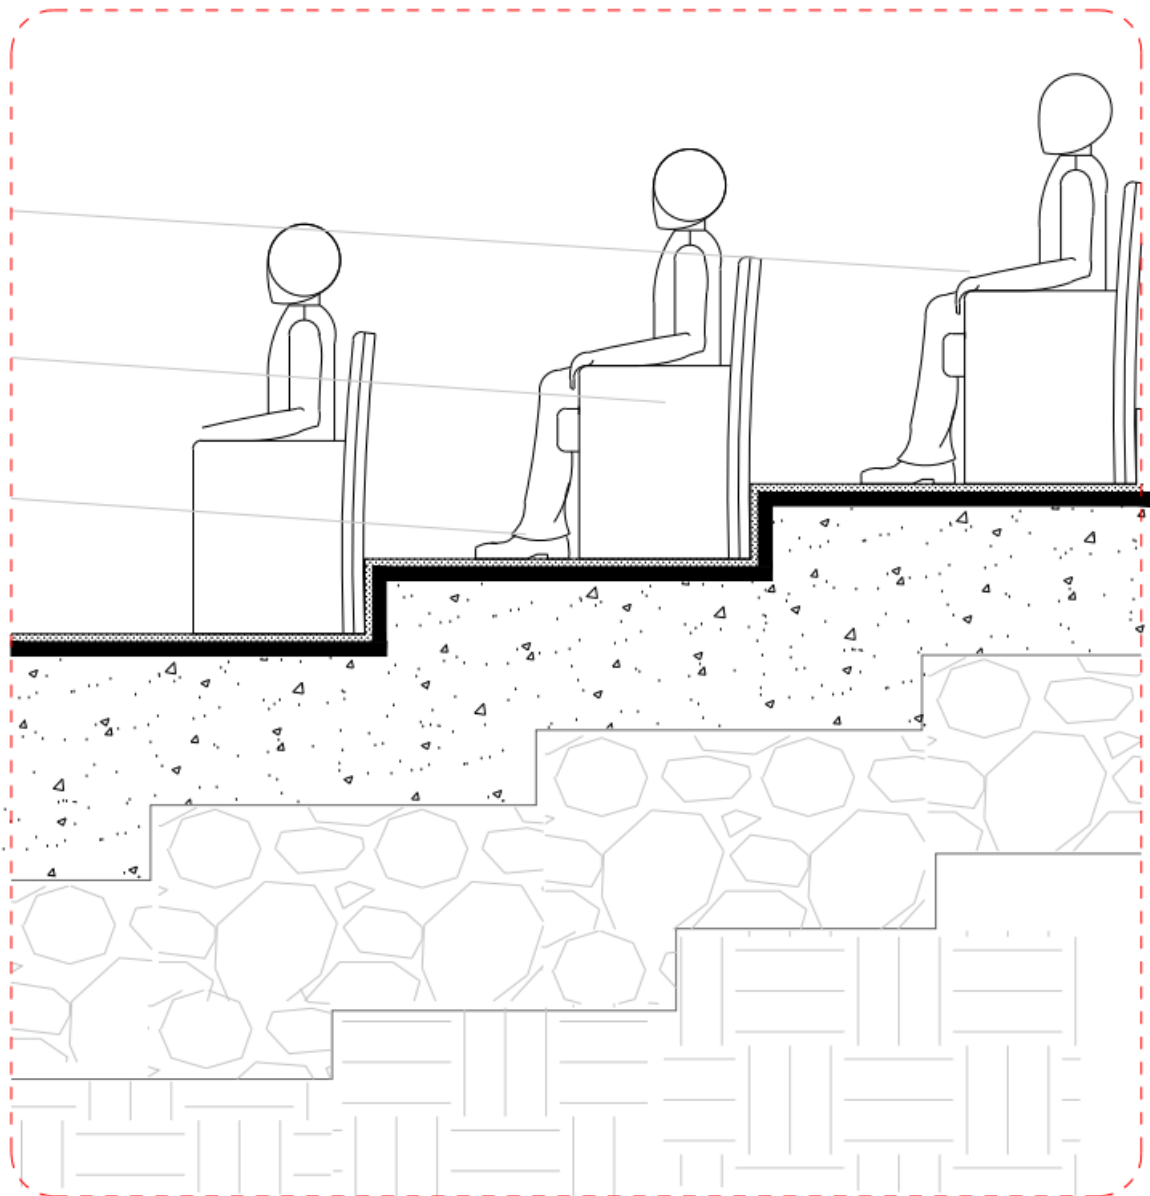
Detalle auditorio, sillas. Fuente, elaboración propia
